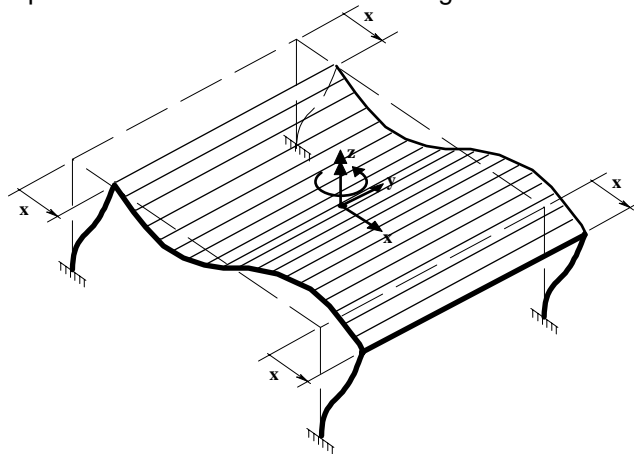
Deformaciones en los elementos de una estructura de un piso, con diafragma rígido en su propio plano, ante un desplazamiento en la dirección x
